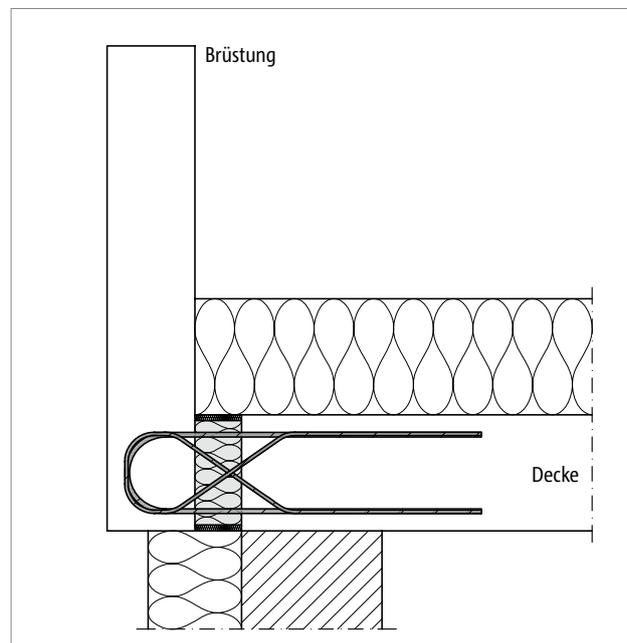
Schöck Isokorb® T Typ AP horizontale Anordnung: Anschluss einer vorgesetzten Brüstung
